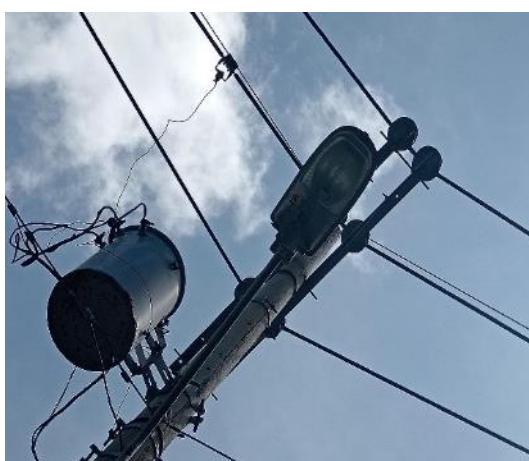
Iluminación en obras del Campo y Planta Geotérmica
